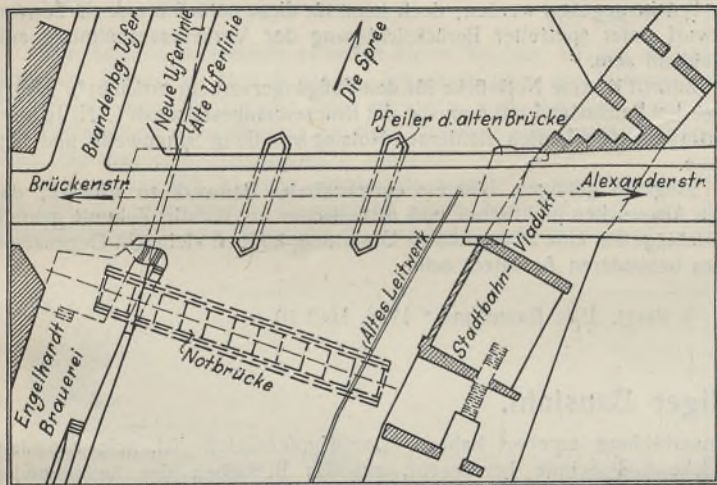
Umbau der Jannowitzbrücke in Berlin: Übersichtsplan.
